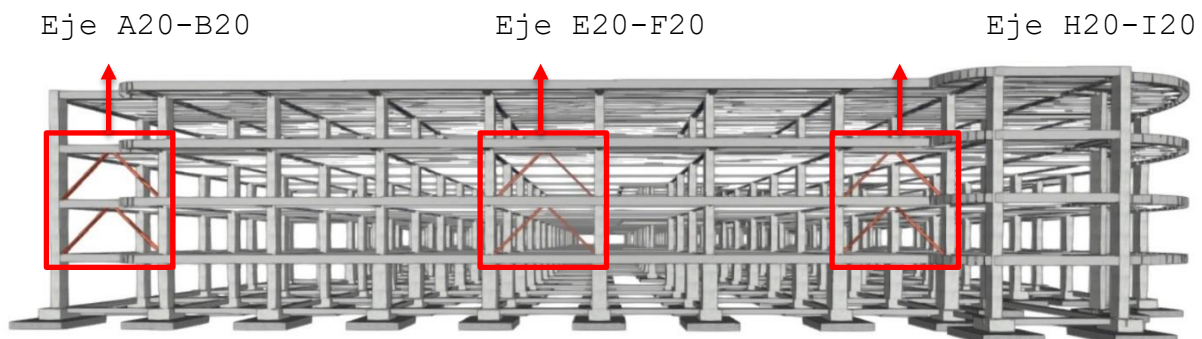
Arriostramiento excéntrico en el eje 20. Vista en alzado.Fuente: propia
